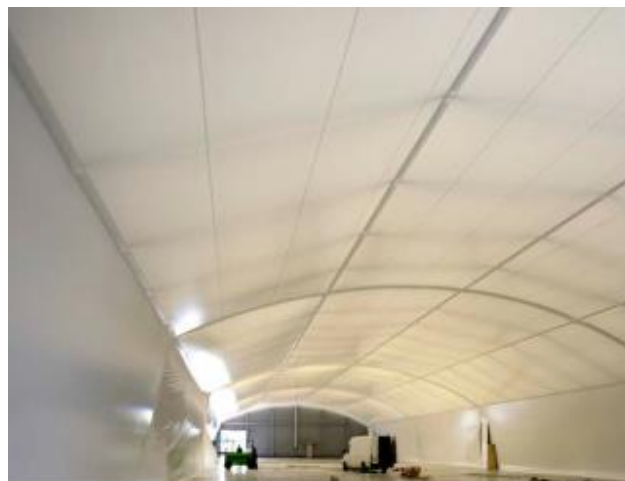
Vinyplan H901 benyttet til telt (Oy Scantarp).
